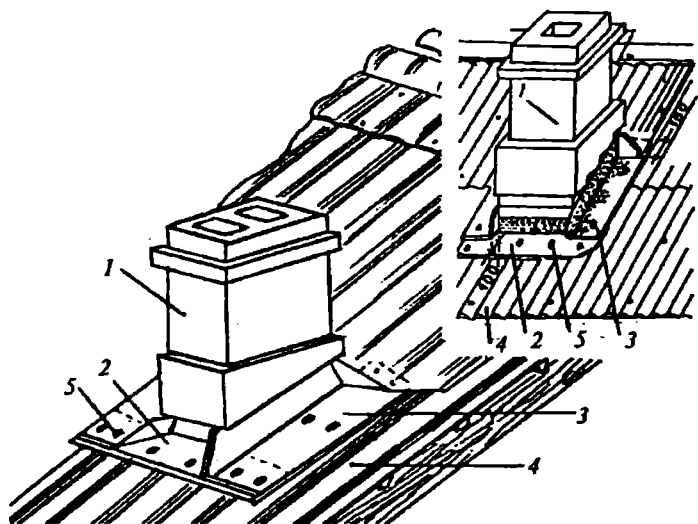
Устройство воротника дымовой трубы (размеры в мм):
